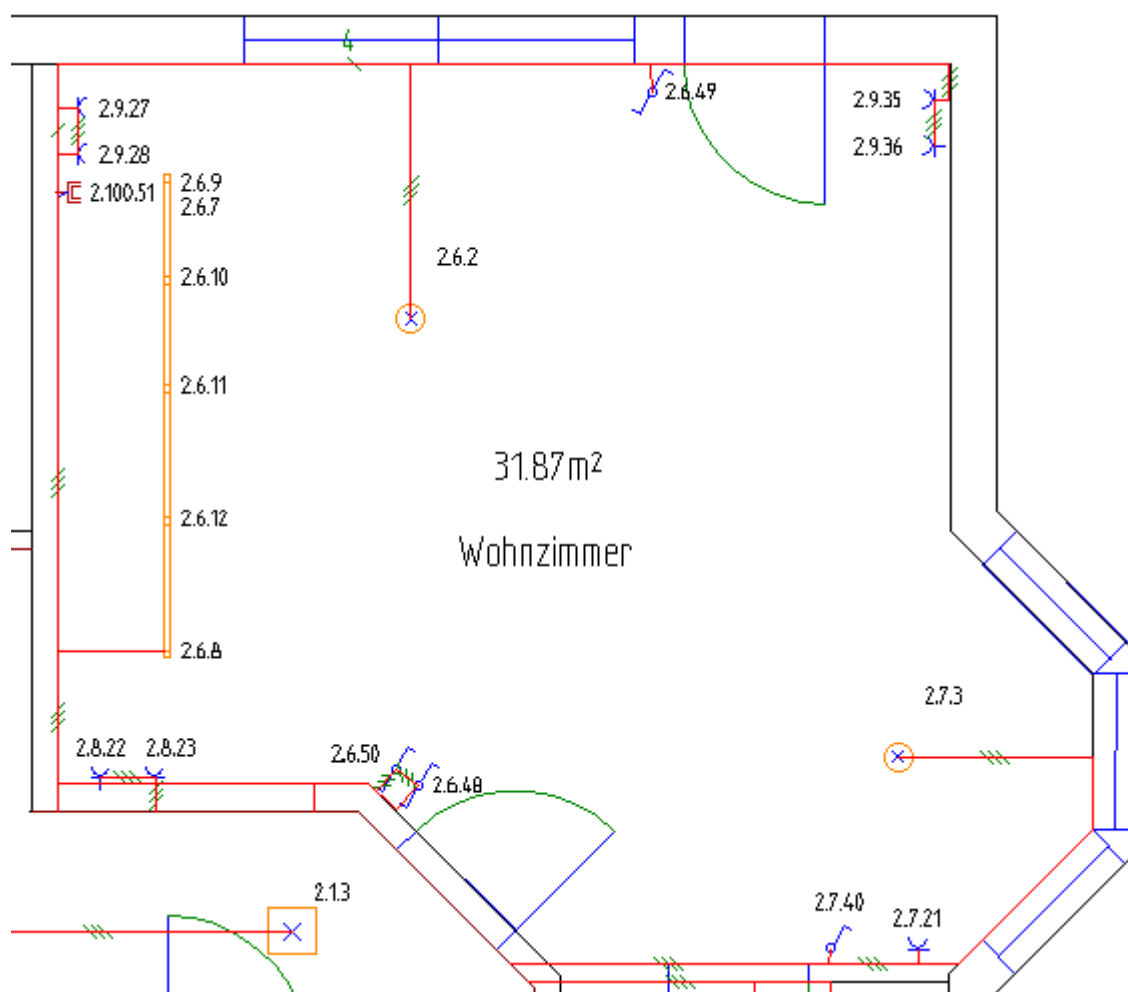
Ausschnitt Grundrisszeichnung nach dem Beschriften
